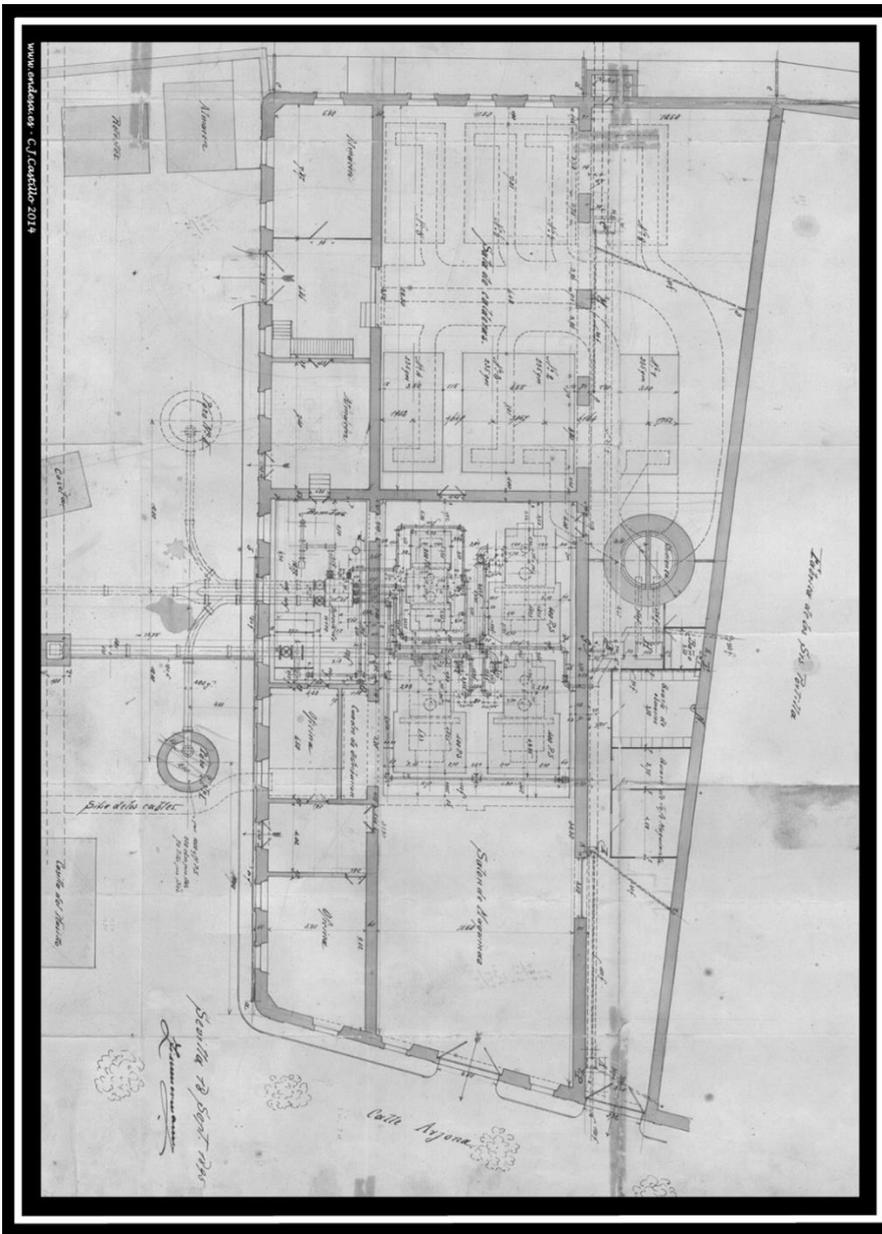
| Plano de Planta de la Central Eléctrica de Sevillana
